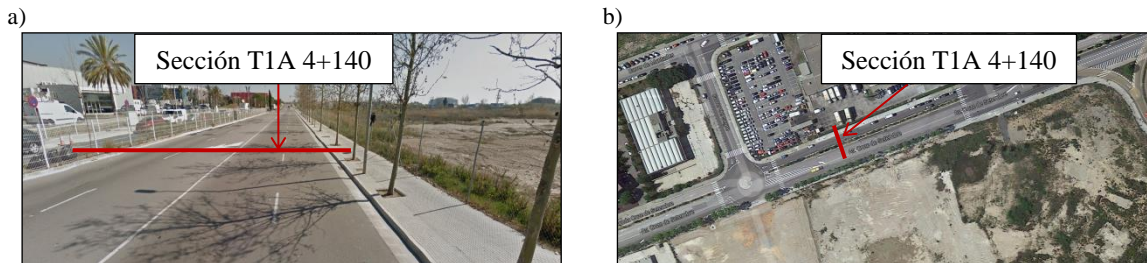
27. a) Vista desde satélite en alzado b) Vista desde satélite en planta, sección T1A PK 4+140. Fuente: Google Maps
